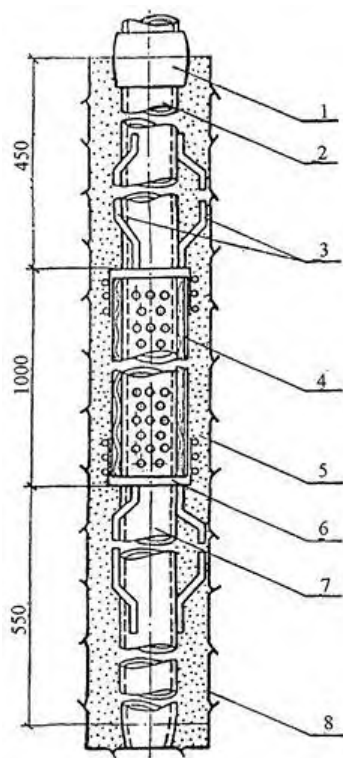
Типовая конструкция водоприемника опускного пьезометра: 1 - соединительная муфта; 2 - винипластовая труба; 3 - направляющие скобы; 4 - фильтр из гофрированной винипластовой сетки и стеклоткани; 5 - песчаная обсыпка; 6 - опорное кольцо; 7 - отстойник; 8 - стенки скважин
